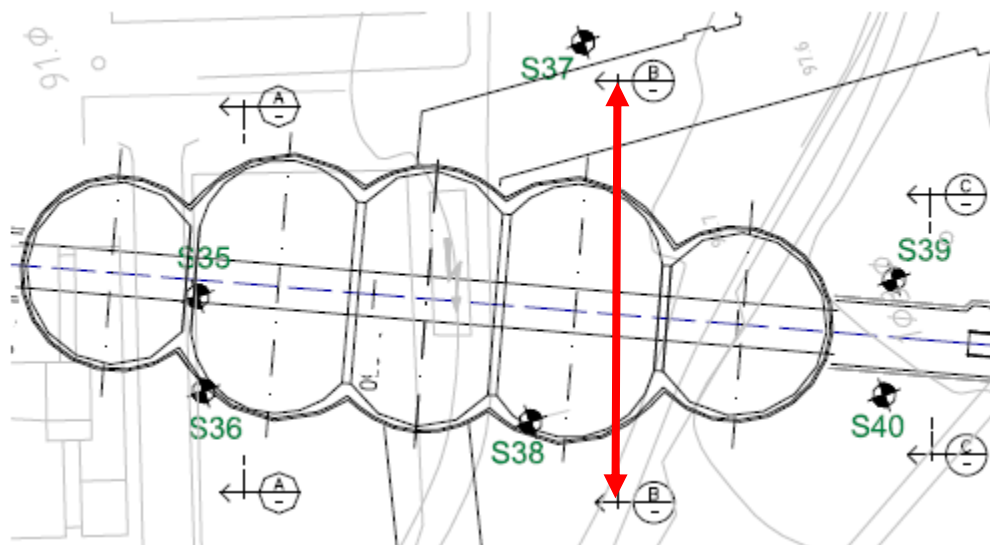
Planta de localização das sondagens executadas na estação.
